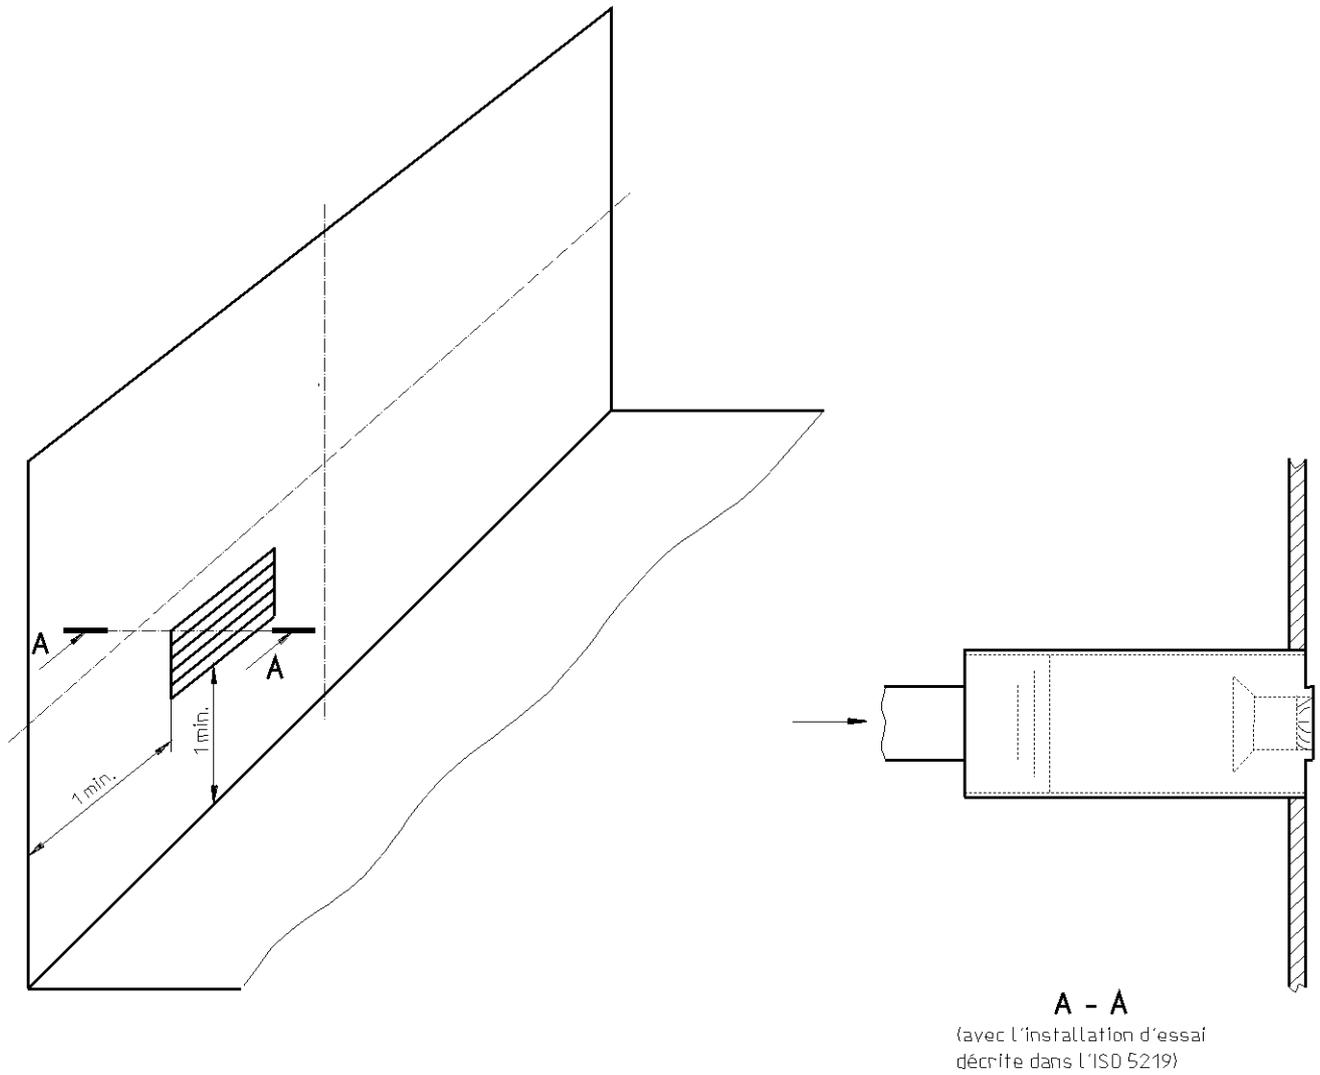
Détail du montage d'une bouche d'air installée sur ou contre une surface
